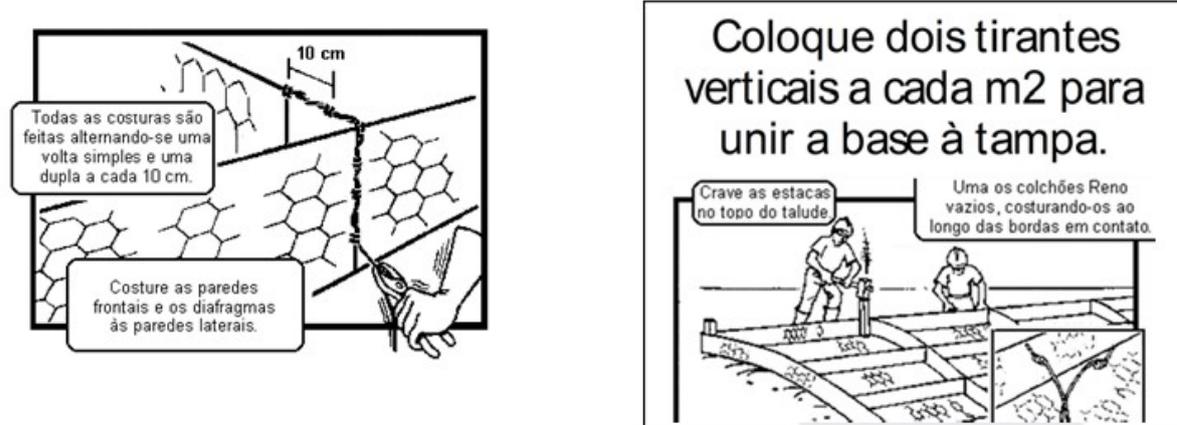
Amarração da parede longitudinal ao diafragma e detalhe do tirante vertical
